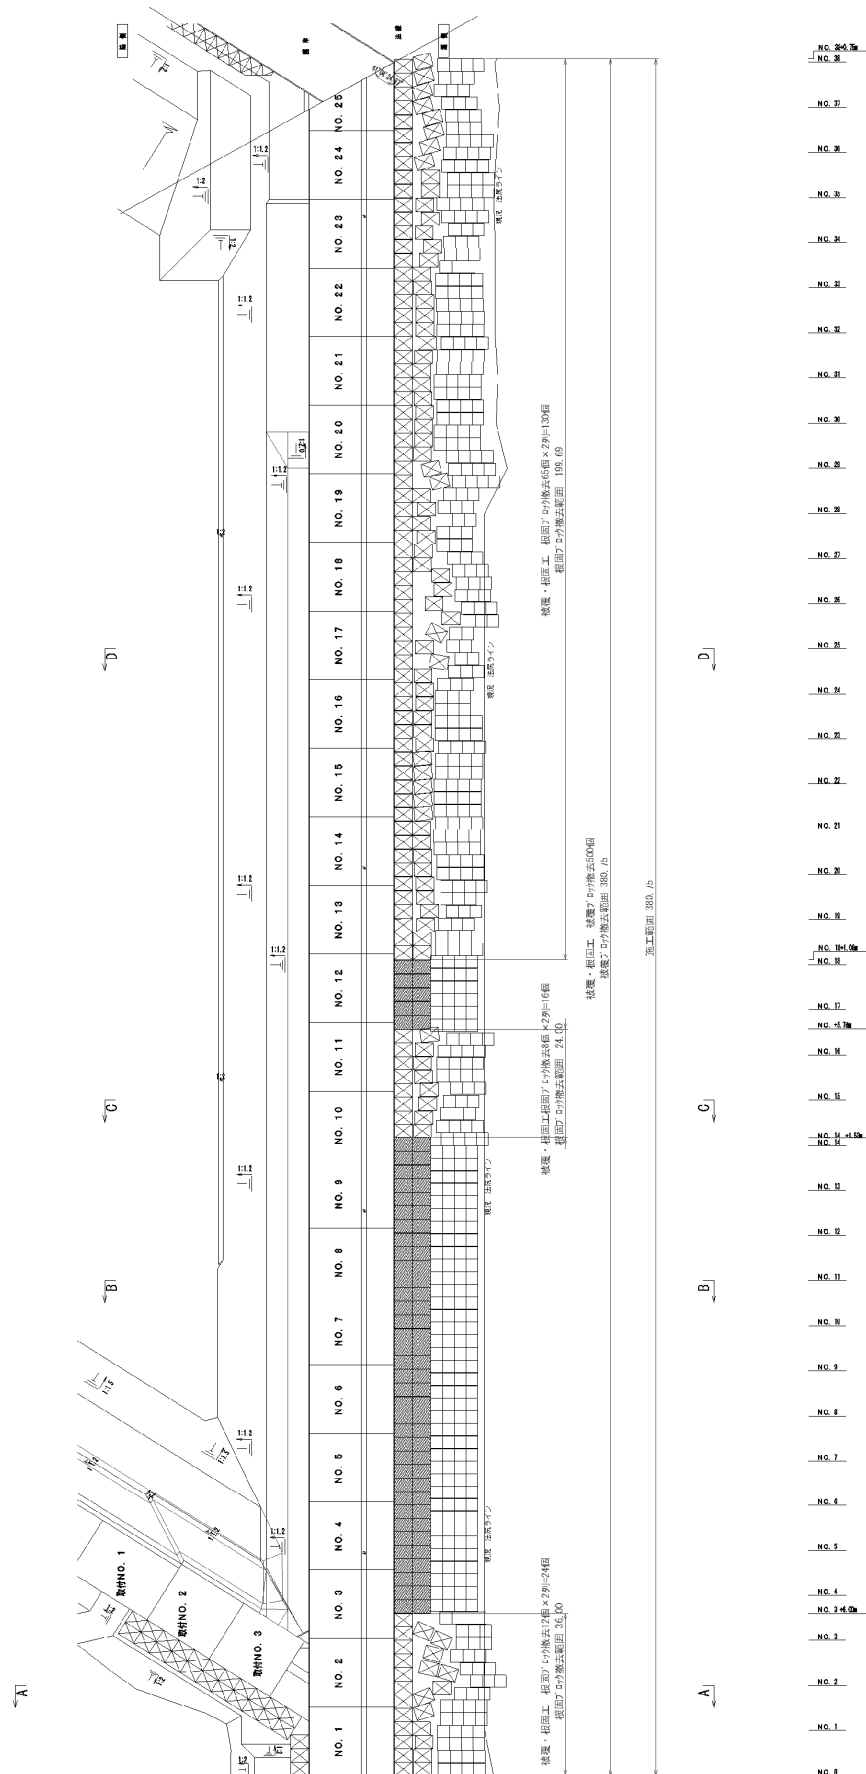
No.1 外港地区防波護岸平面図(復旧前)_撤去平面図
